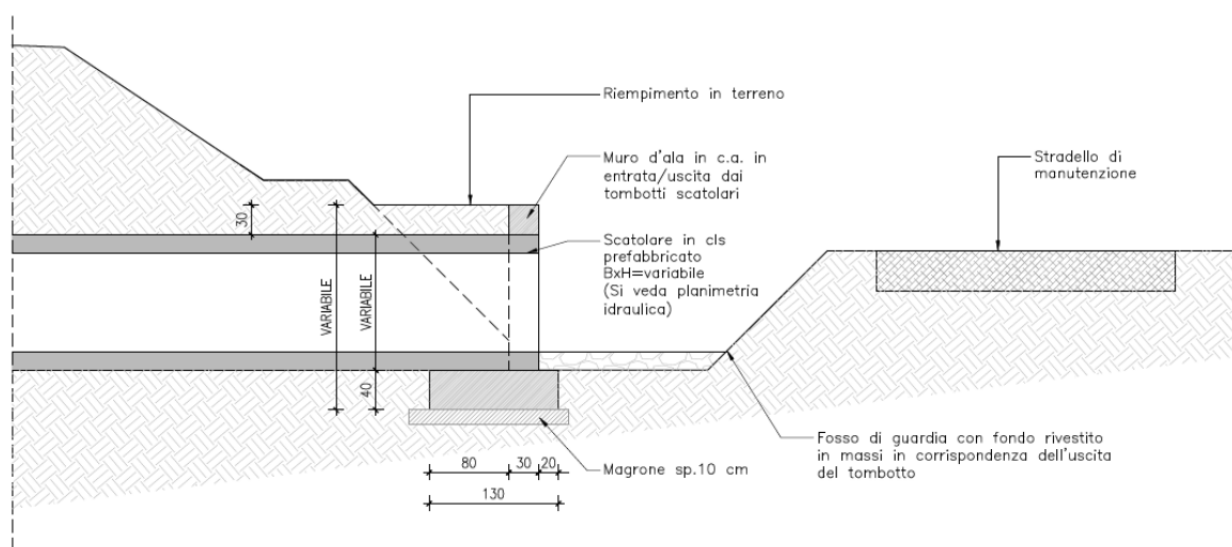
Sezione tipo d'imbocco/sbocco attraversamenti idraulici
